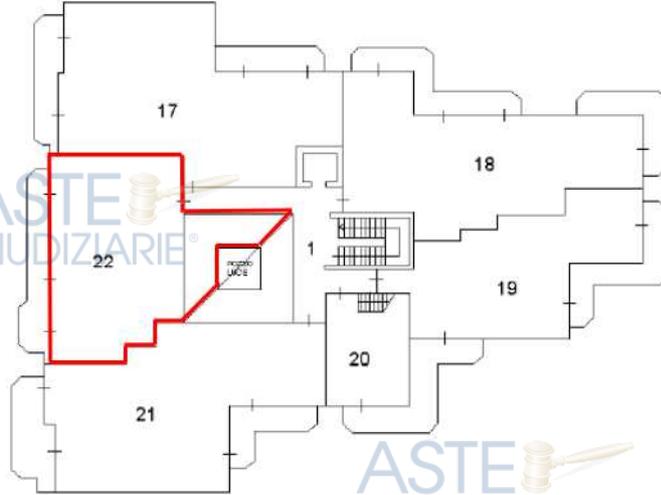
Estratto dell'Elaborato Planimetrico, dal quale dedurre i confini dell'unità
